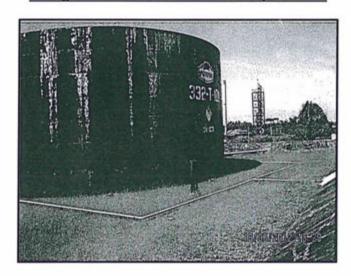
Vista del Tanque 332-T-118, en la cual se visualiza el área estanca con material no impermeabilizado, cubierta con vegetación.
